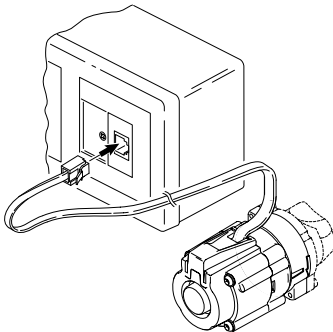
Pumpenkabel am Modul Heatfixx aufstecken
